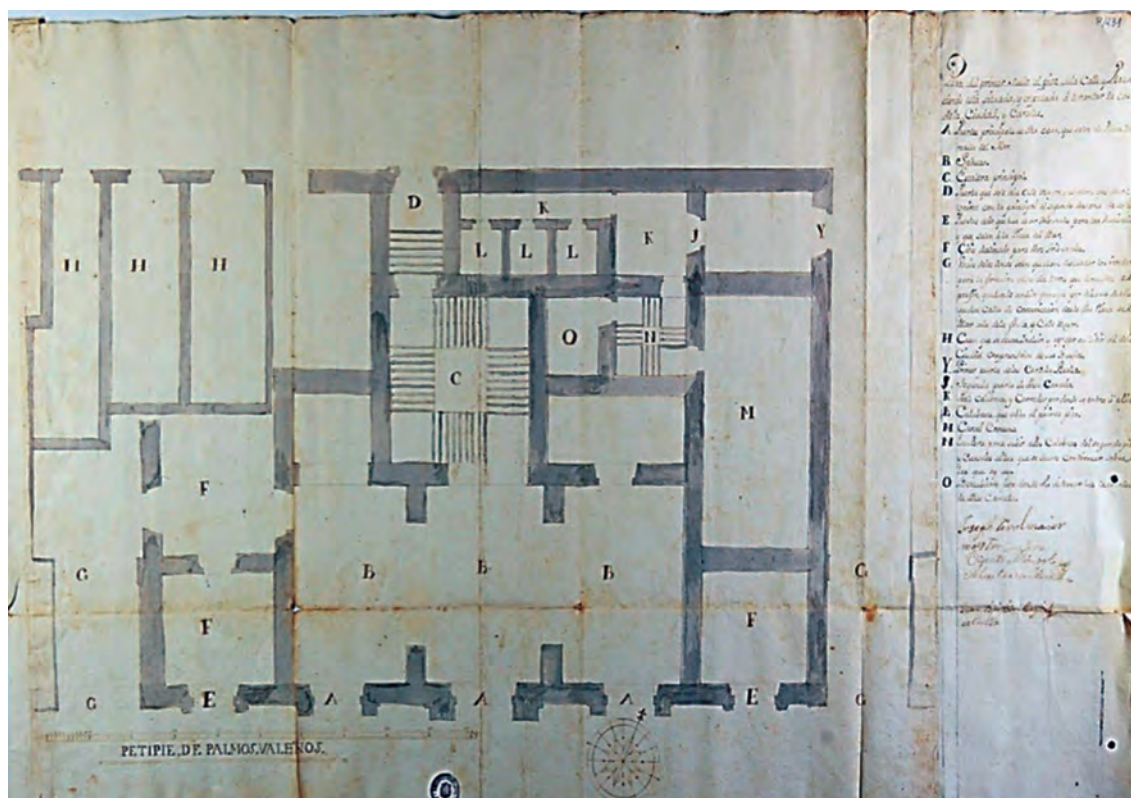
Juan Bautista Borja, Vicente Mingot y José Terol. *Diseño de la planta baja del Ayuntamiento de Alicante (1730).
